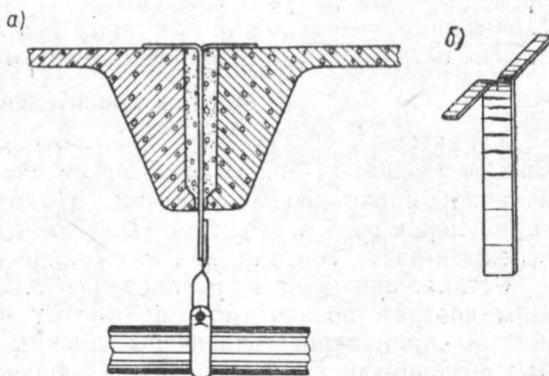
Крепление трубопровода к сборному железобетонному перекрытию
